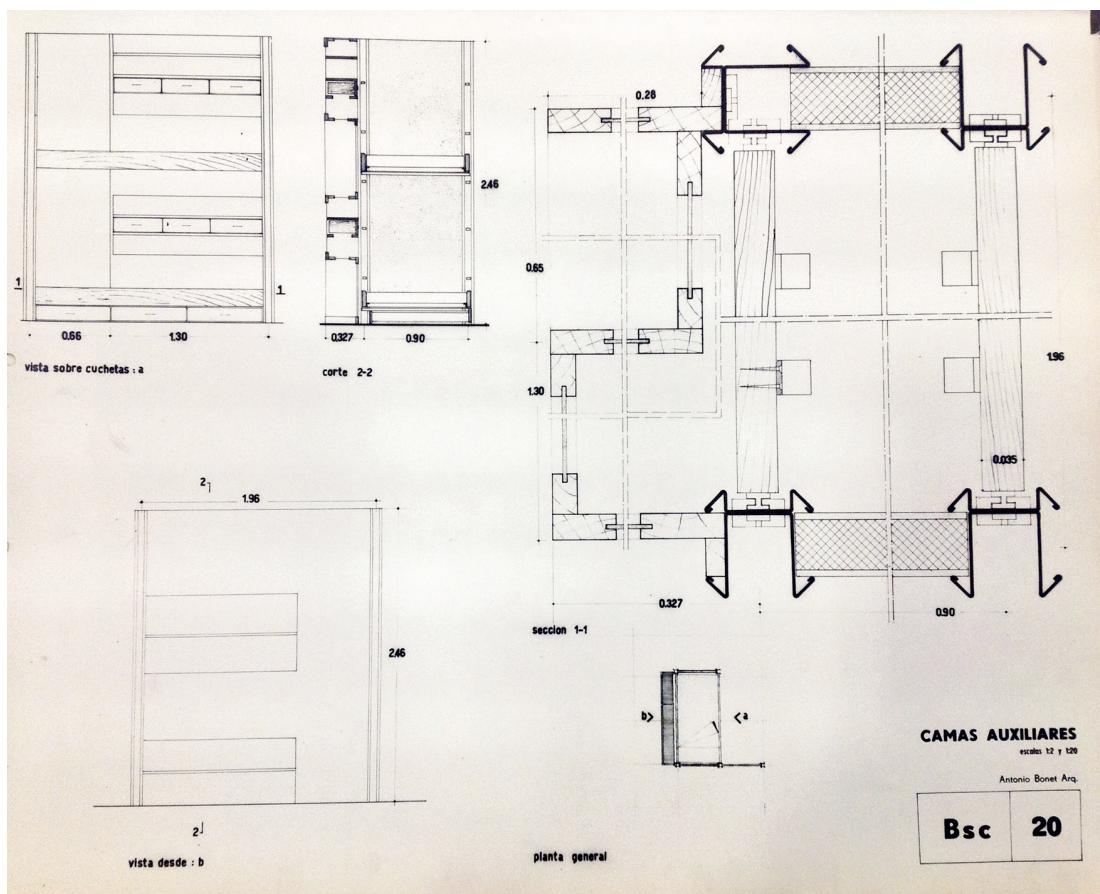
Sistema BSC. 1953-56. Detalle del mueble con las camas auxiliares. Plano Inédito.
